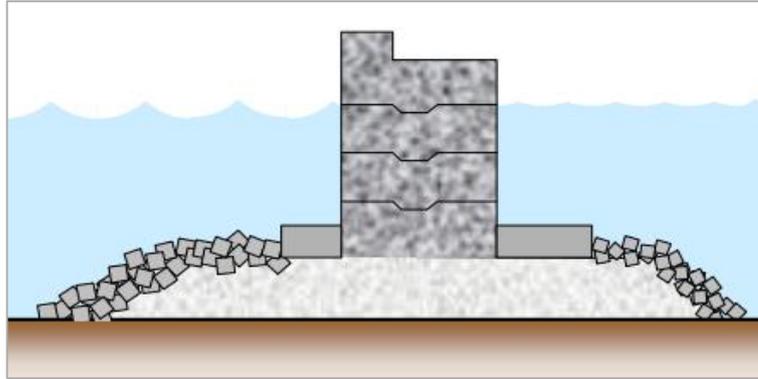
Sección transversal de un dique vertical cimentado sobre un fondo de escollera
